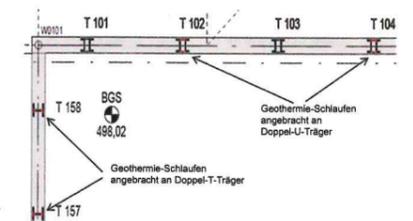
Beispielhafter Grundriss einer Baugrube mit einer umschließenden BAUER-Energiewand
